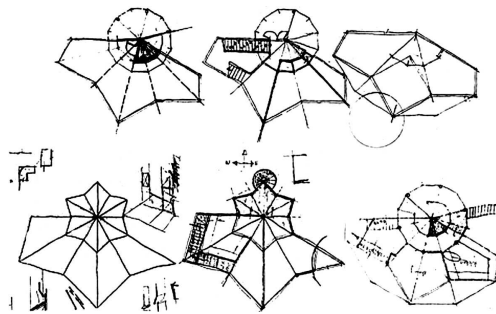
ábra A Carpenter-Hall ház hengeres vasbeton (fent) és favázás verziójának homlokzatai
